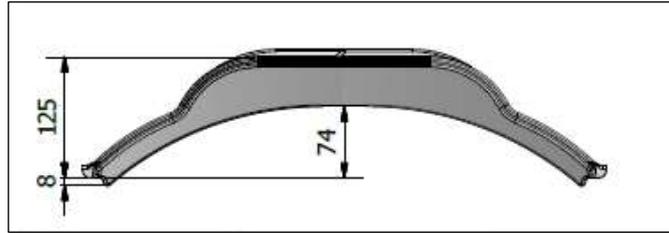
Prescription de forme pour les entrevous Neobois hauteur coffrante 160 mm et poutrelles DF
